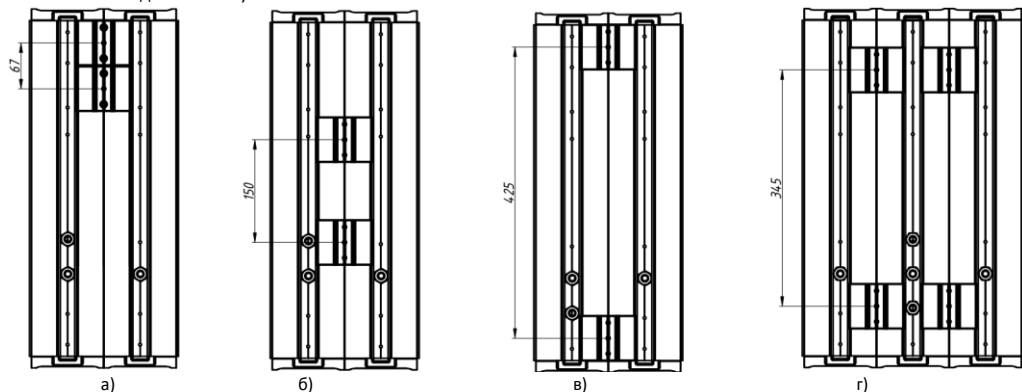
Расположение планок (на примере Element 0,5x2 и 0,5x3) для установки креплений:
